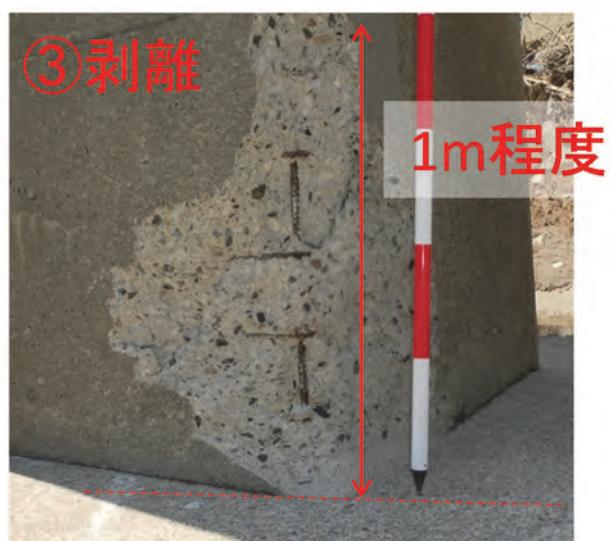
P2 橋脚基部の下流側のコンクリート剥離の状況（下流側から撮影）
